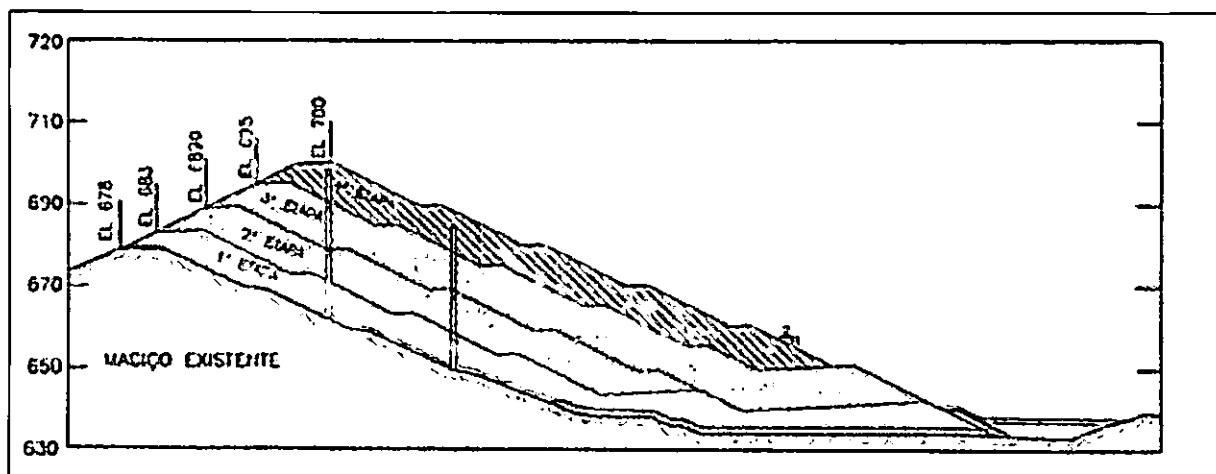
Seção típica do 1º alteamento da barragem até a elevação 700 metros (Fonte: Manual de Operação da Barragem, 2019).
